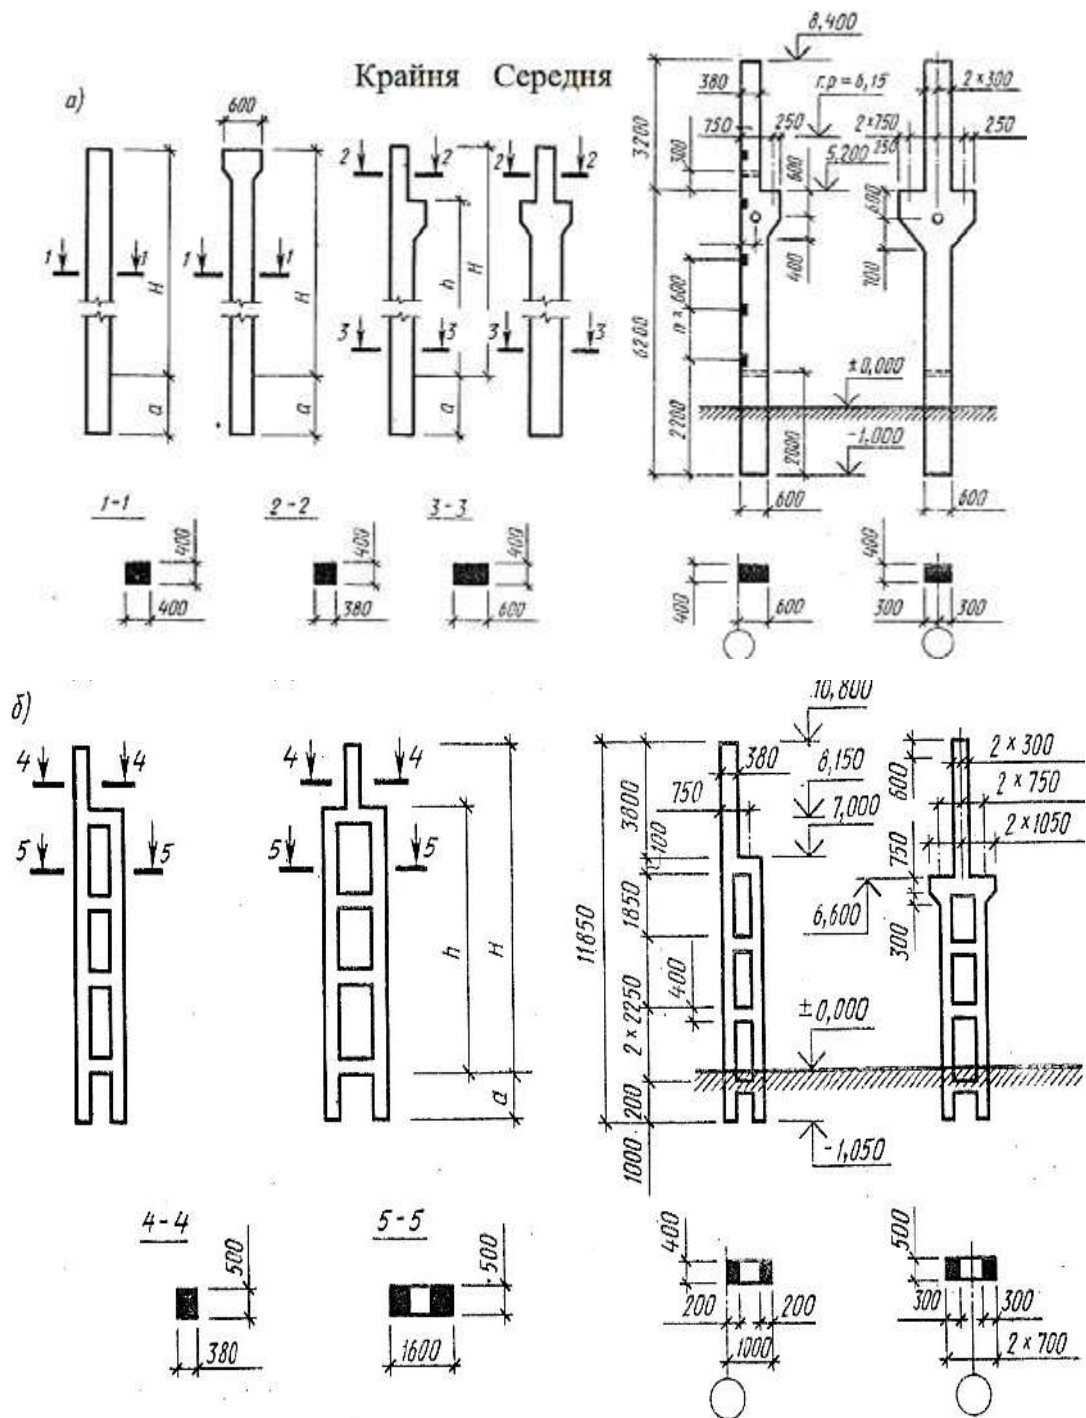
Залізобетонні колони одноповерхових промислових будівель:
